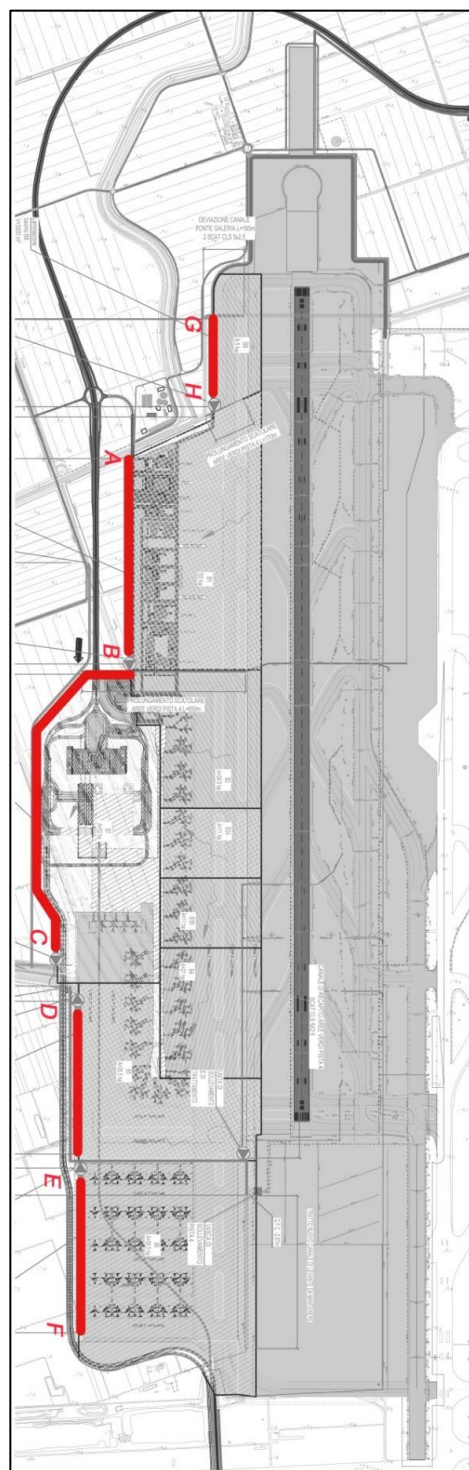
Schema dei canali di laminazione e sezione tipo.
